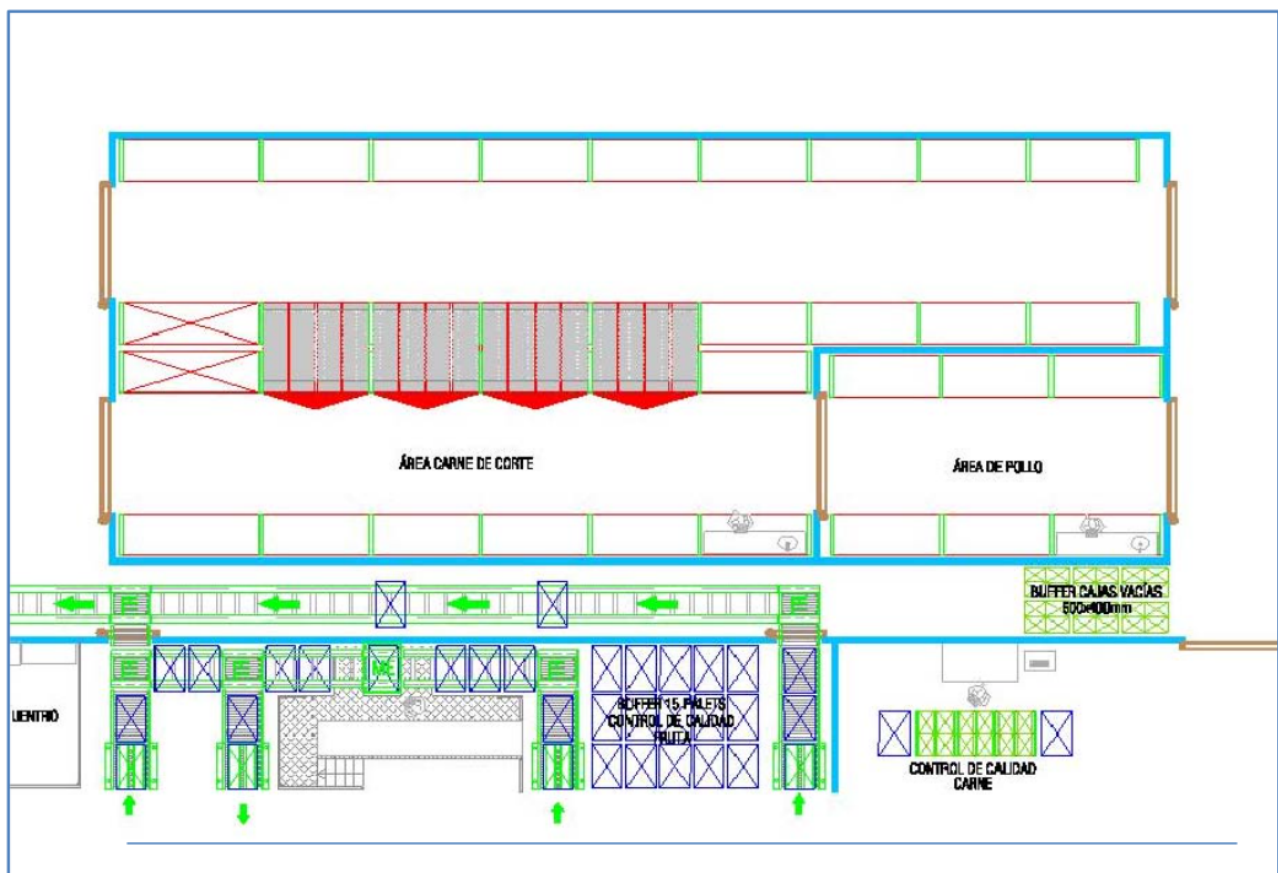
Detalle área estantería paletización escenario automático Fuente Elaboración propia
